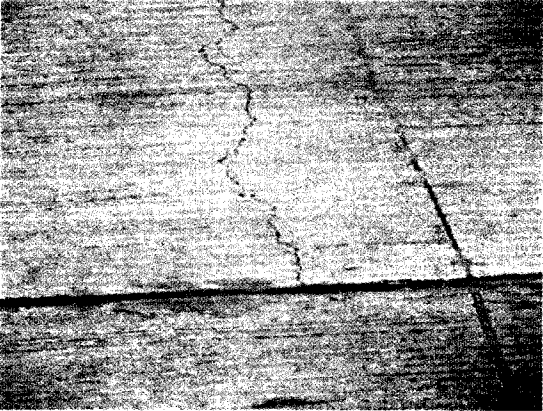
06/03/2015: Fisuras en zarpa de hormigón en calle Francisco Bilbao entre Alejandro Gutiérrez y Alfonso Serrano.
